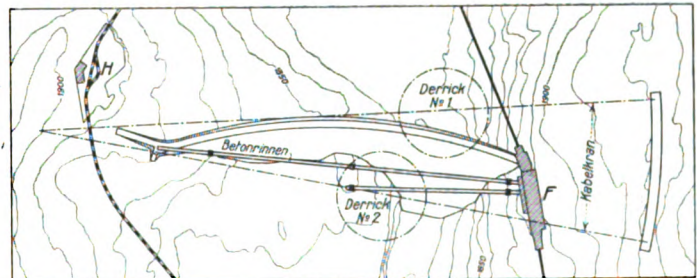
Situationsplan der Staumauer-Baustelle mit Angabe der vom Kabelkran und den Derrick-Kranen bestrichenen Flächen. — 1:5000.
